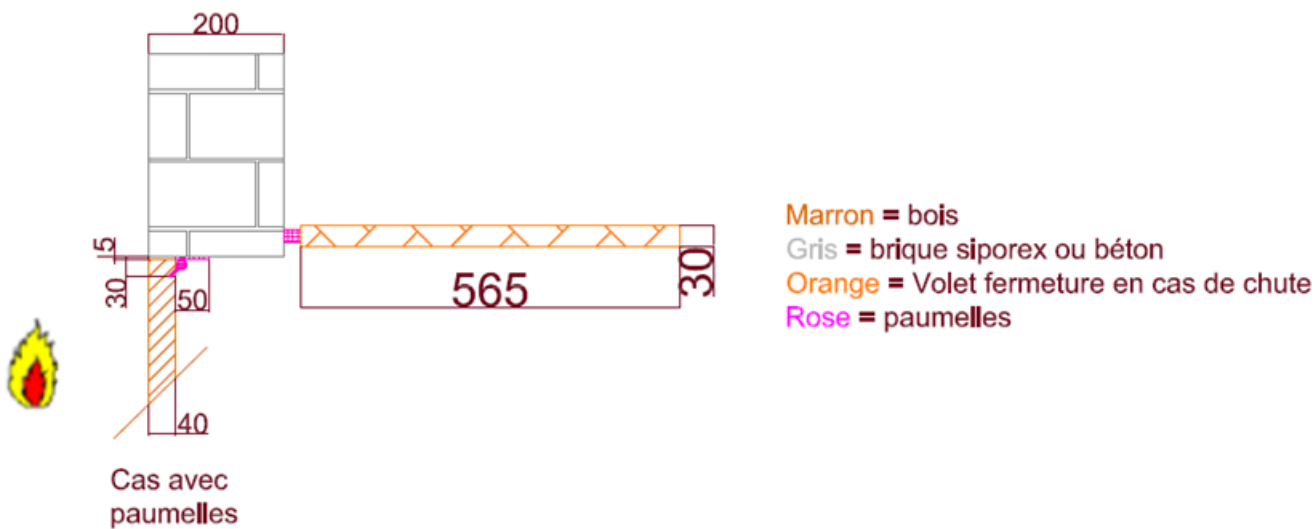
Plan de montage pour le panneau d'aggloméré de lin fixé sur paumelles.
